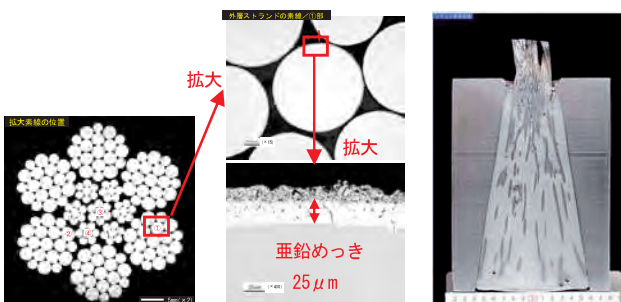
ハンガーロープ断面観察 写真-39 ソケット断面
